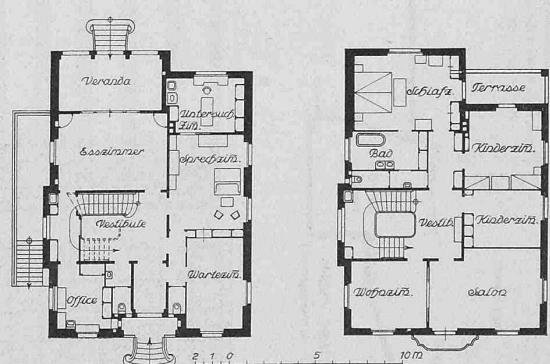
und 2. Grundrisse. — 1:400.
